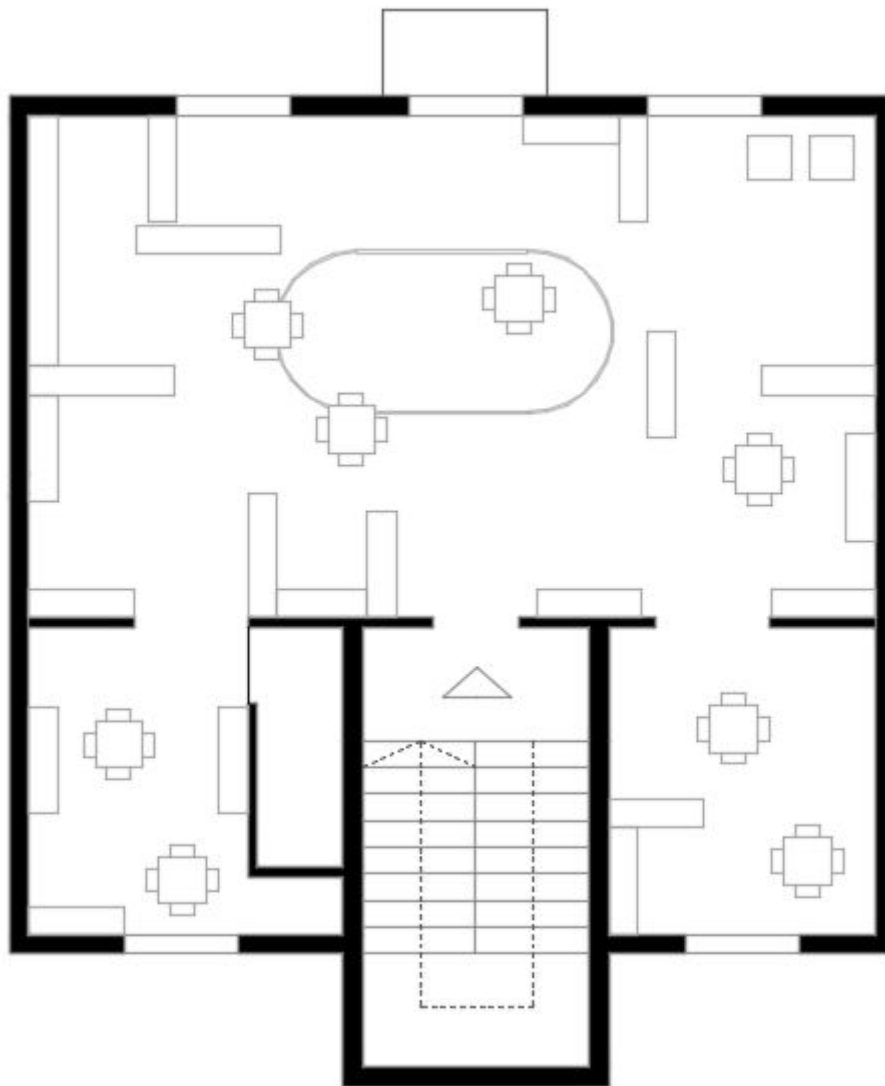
Espacio de acceso al aula. Planta del aula del Jardín de Infancia Montessori en Cracovia. Planimetría realizada por la autora.
